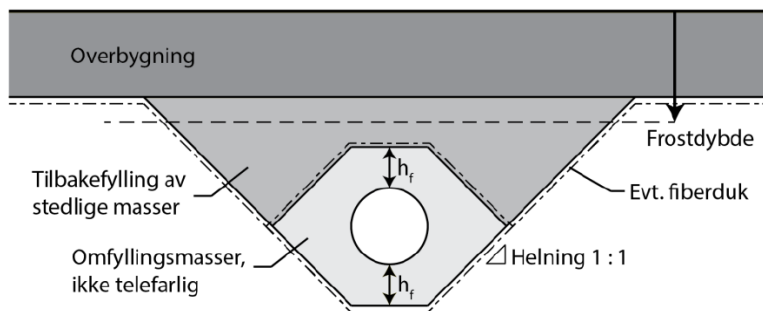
Utkiling rundt stikkrenne beliggende over største frostdybde /1/
